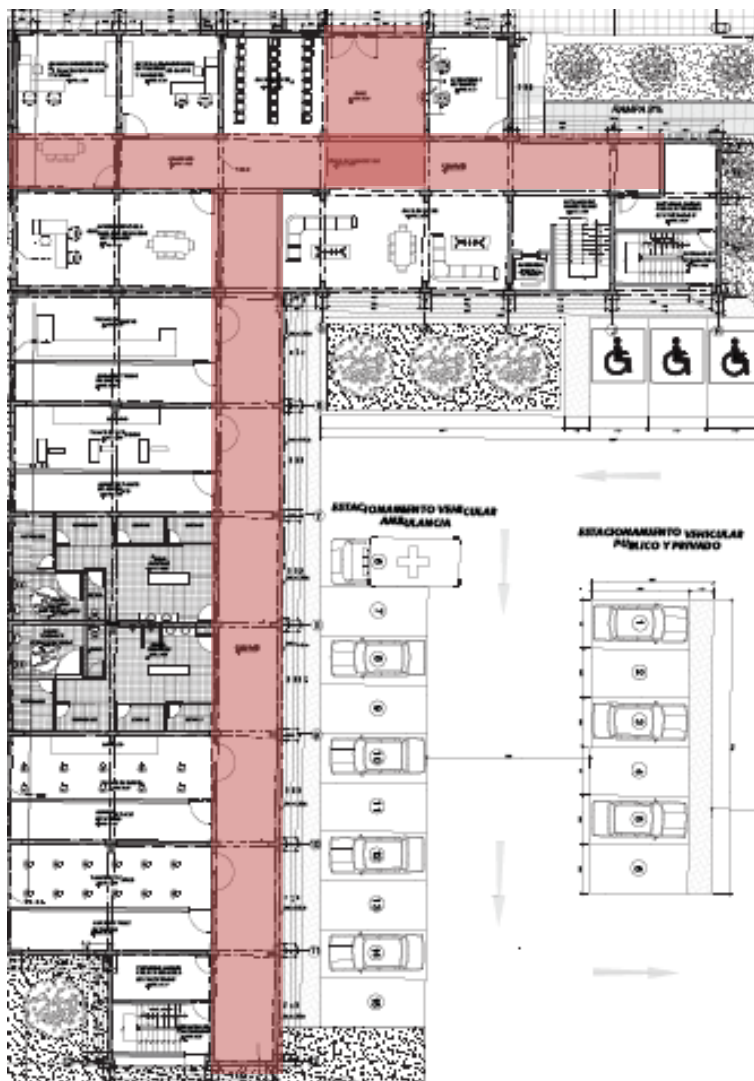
Pasadizo – Zona educación. Fuente: Elaboración Propia
